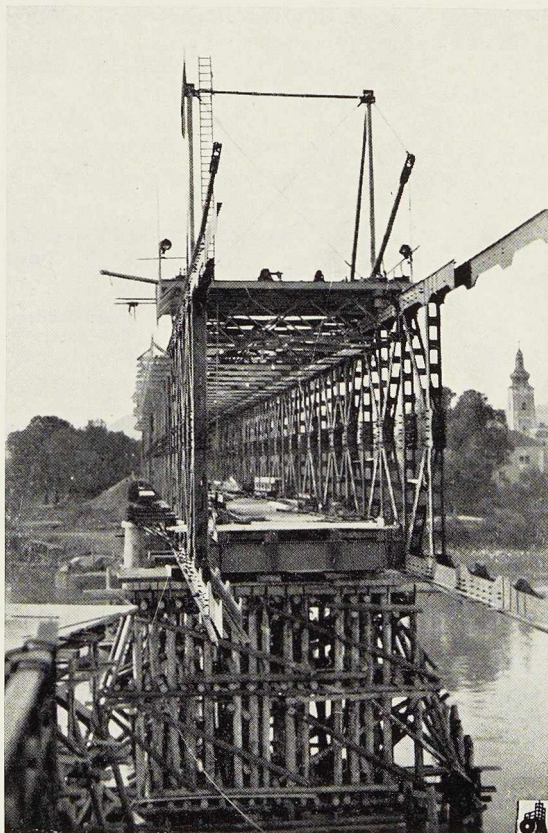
Construction en porte-à-faux des éléments du type R. W. Vue d'enfilade dans la deuxième travée, montrant la pile auxiliaire.
